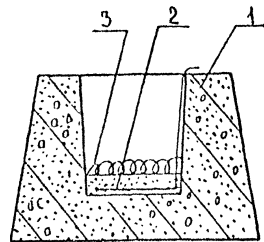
Обогрев подставки под колонну нагревательными проводами
